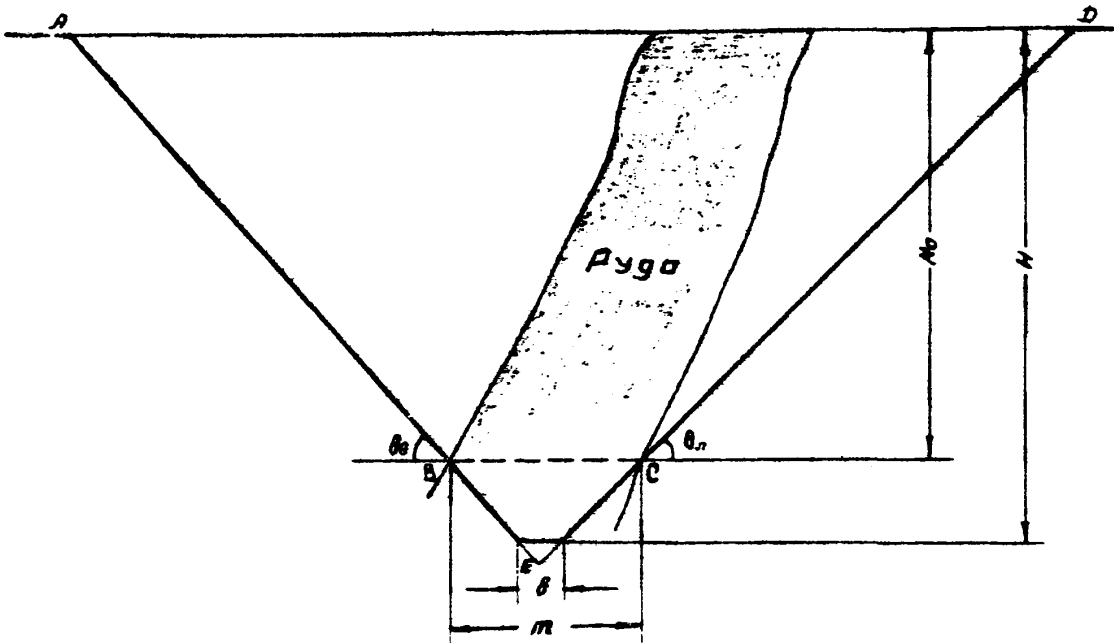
Расчетная схема определения границ карьера на поперечном разрезе.
